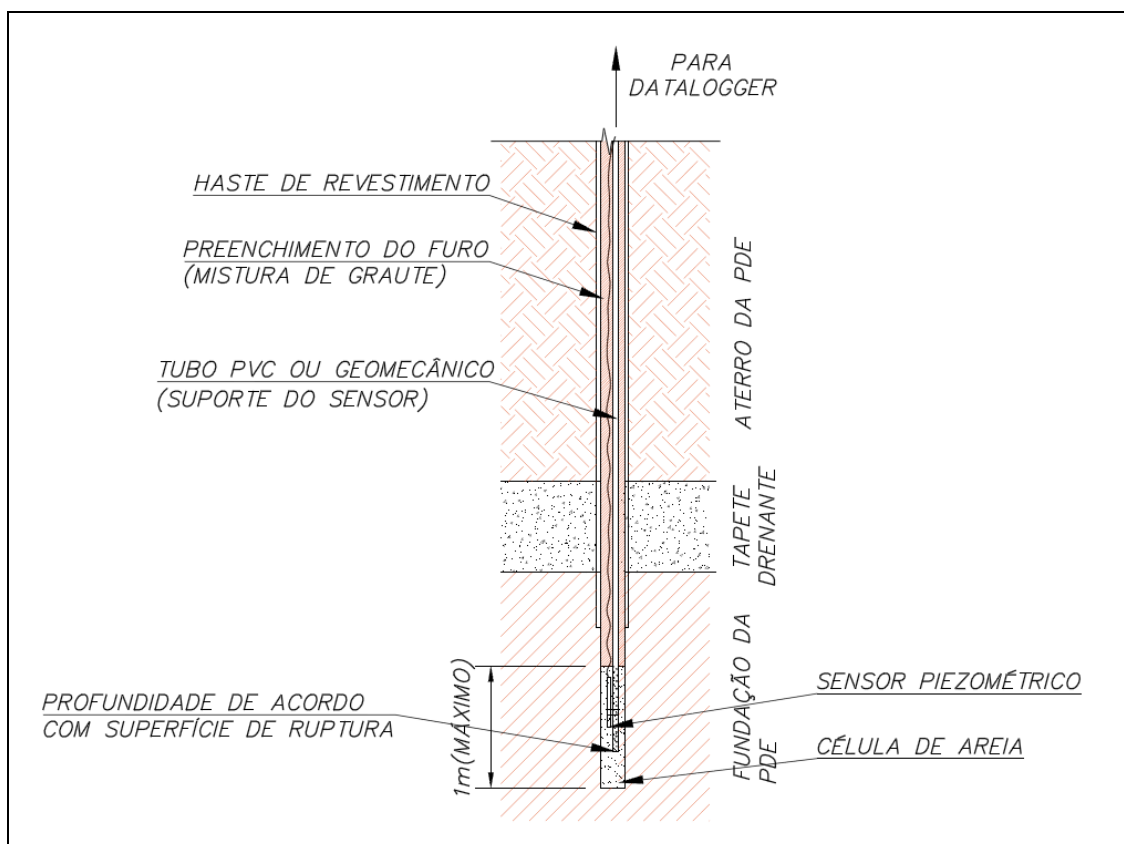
Perfil construtivo típico de um piezômetro Casagrande instalado em fundação de PDE (Fonte: O autor, 2016).
